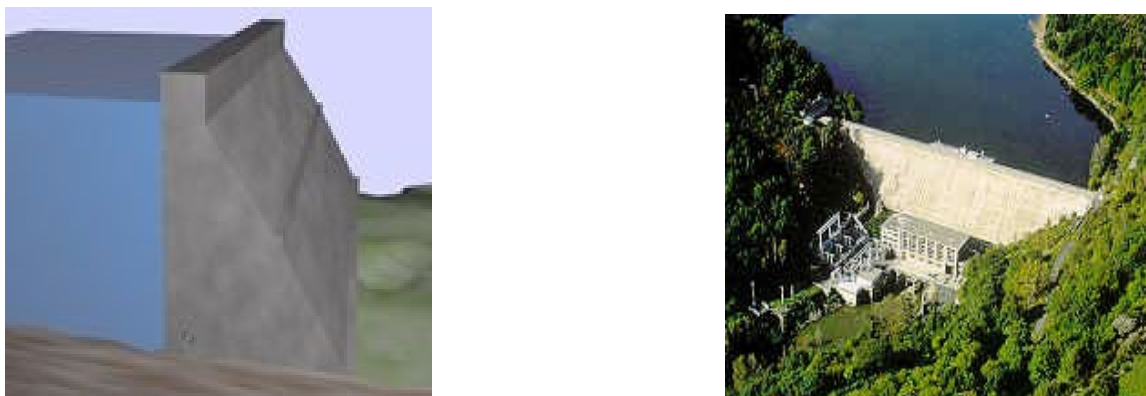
Schéma et photo d'un barrage en poids (Site web 2).
